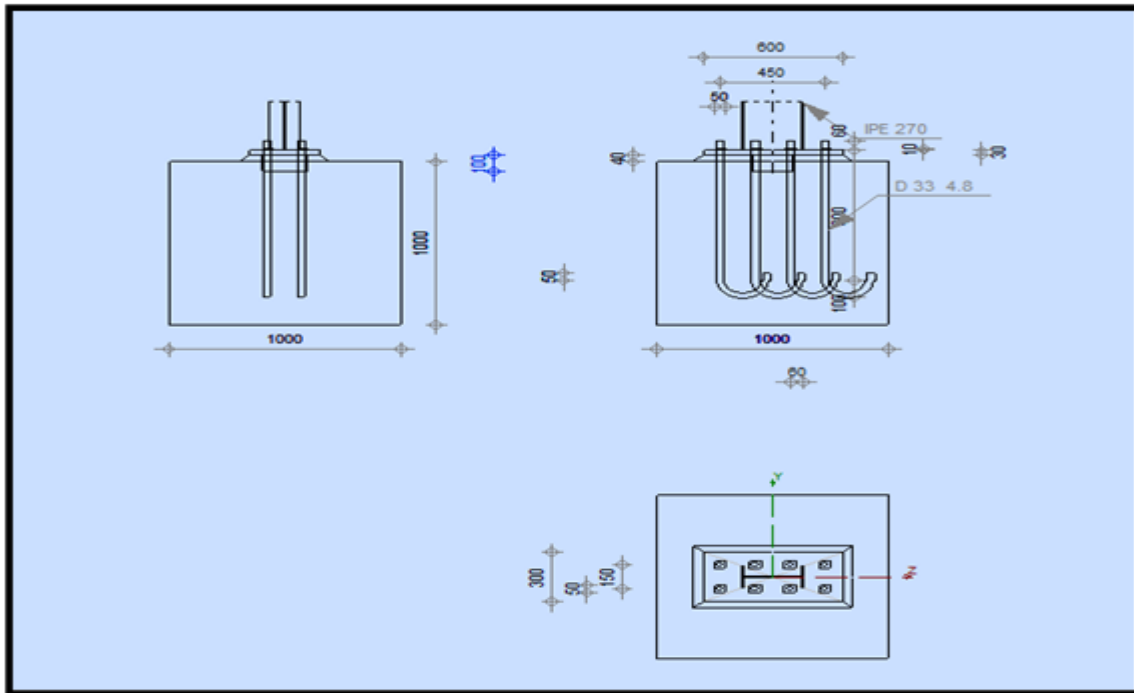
Vue en plan de l'assemblage pied de poteau
